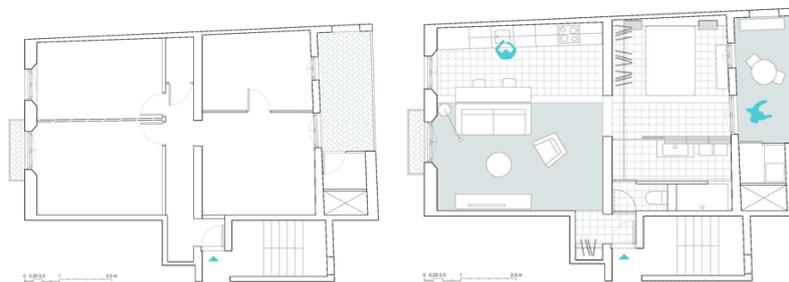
Planta do espaço original e planta do espaço depois da intervenção. Fonte: DezeenMagazine
